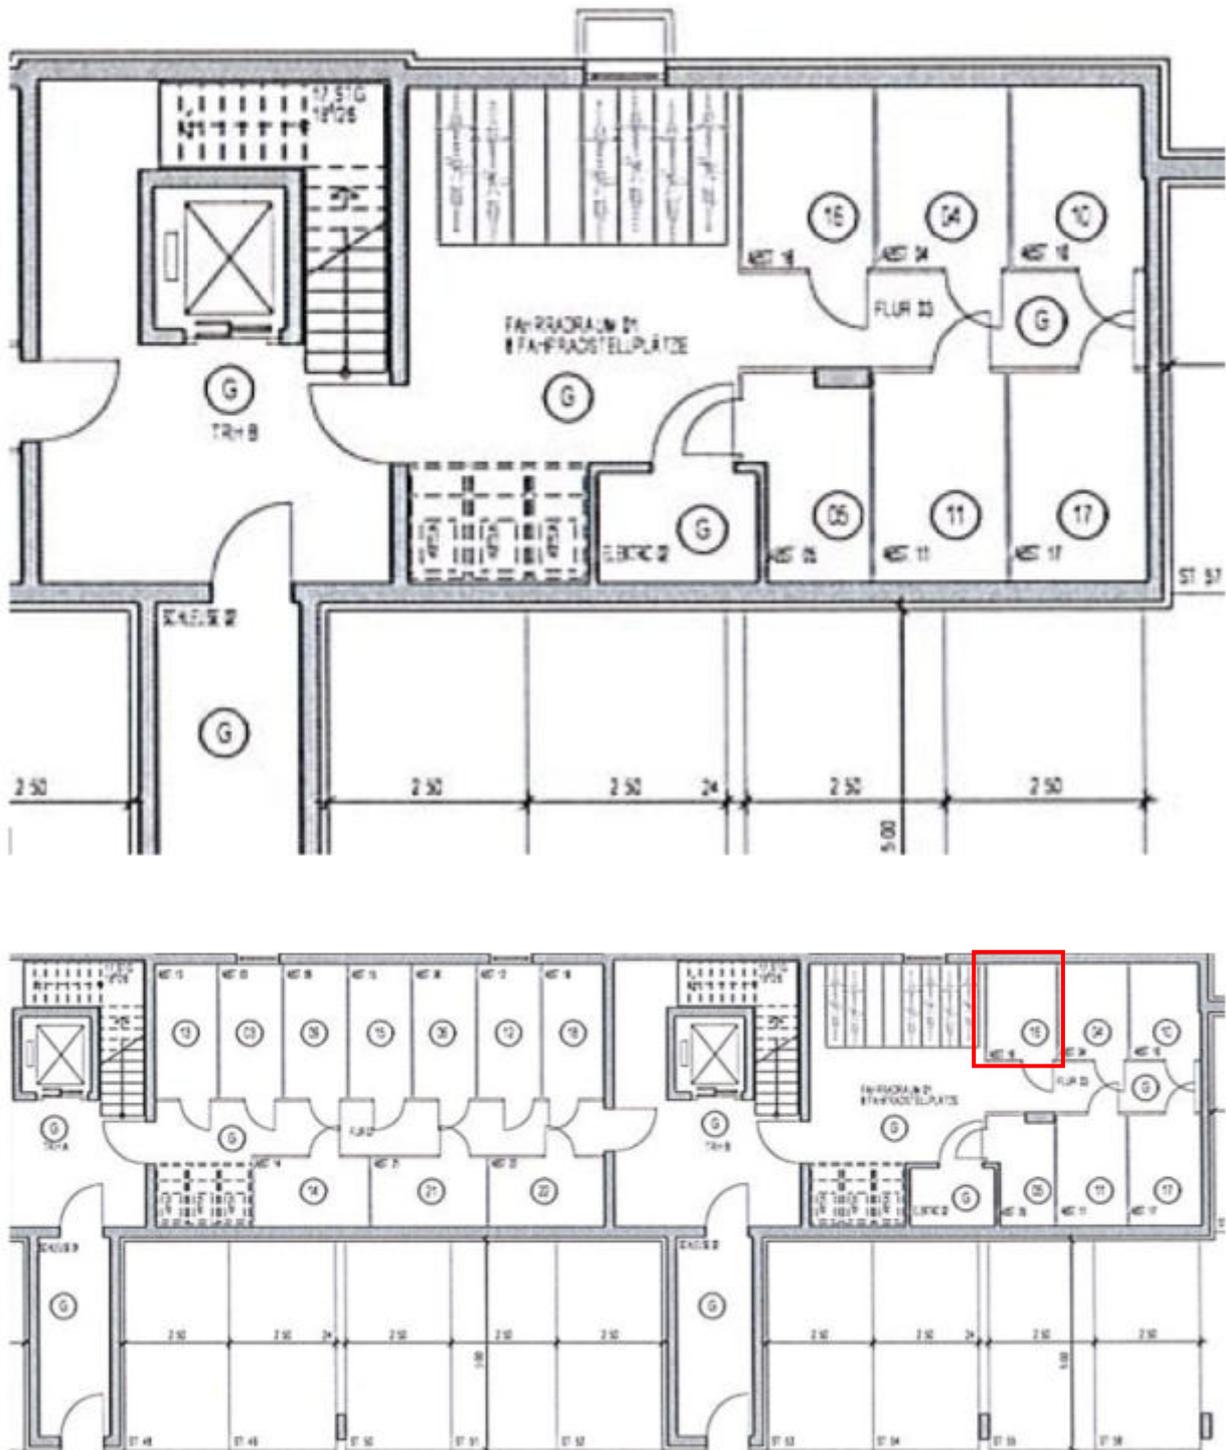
Grundriss UG/Abstellräume (Ausschnitte ohne Maßstab); Quelle: Anlage 1 zur Urkunde 303/2021/ Teilungserklärung vom 10.02.2021, Roteintragung - Lage von Abstellraum Nr. 16 - durch den SV
